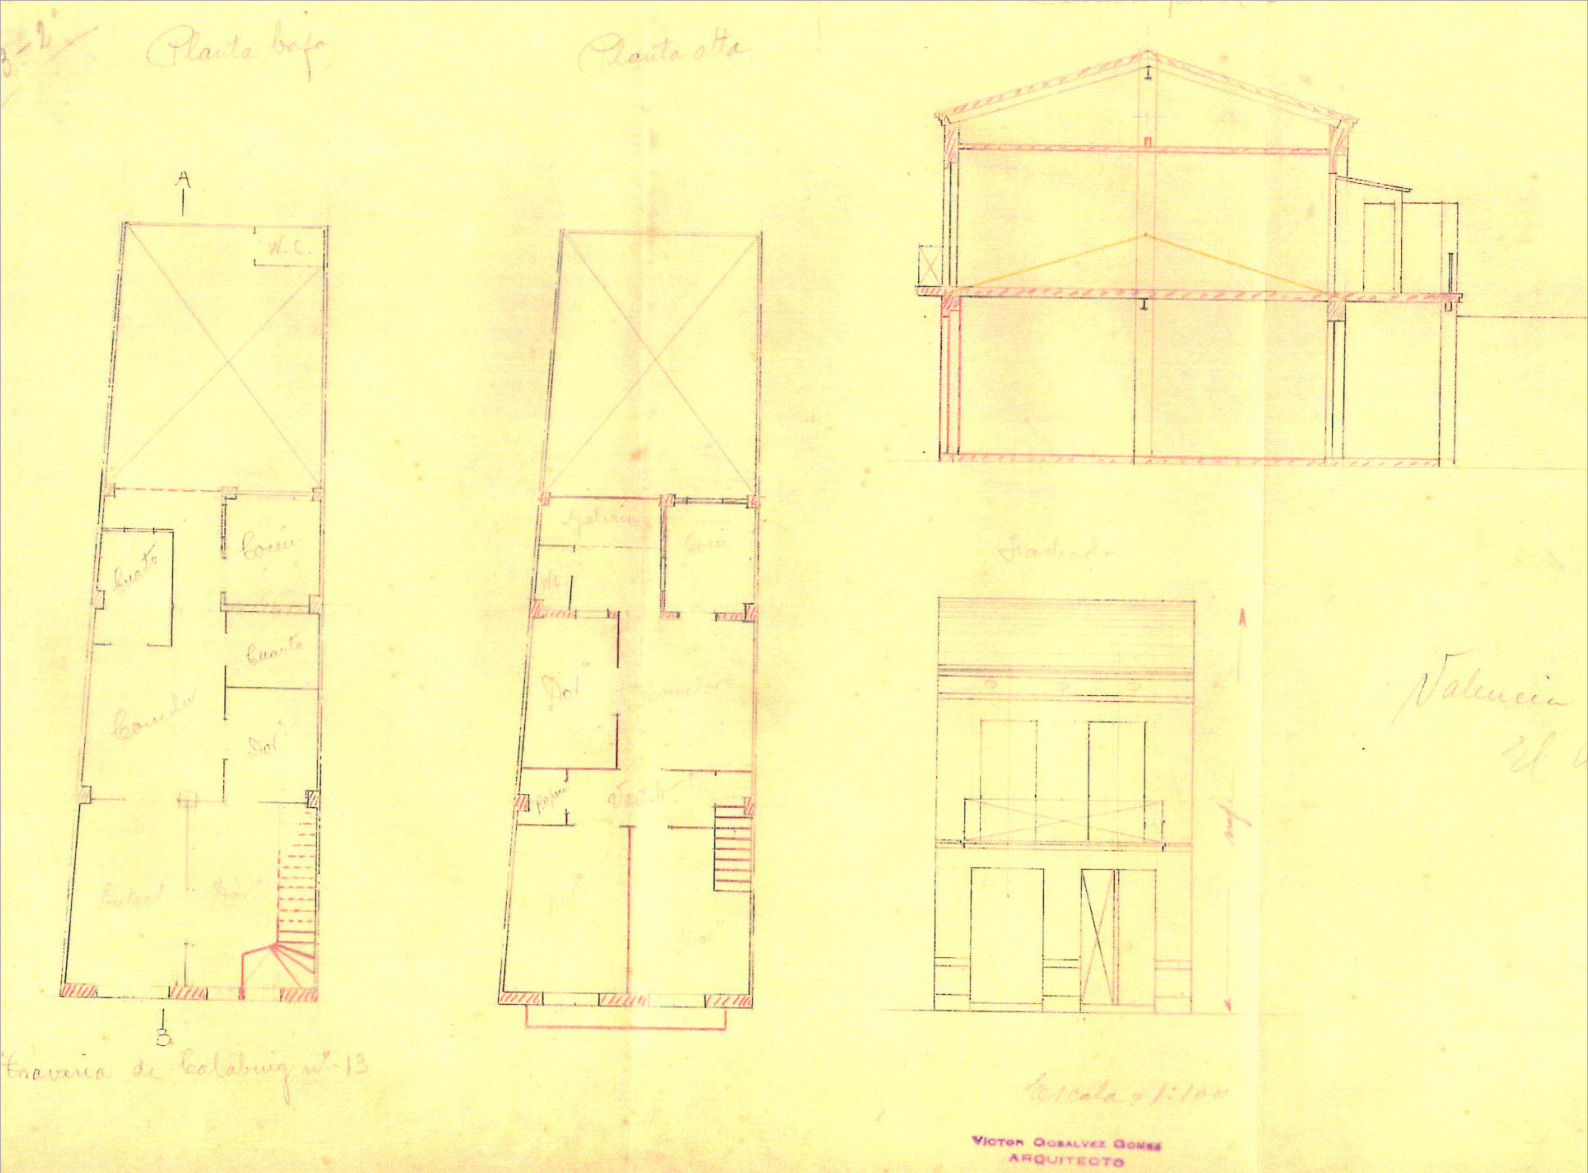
Proyecto de elevación de piso y reconstrucción de fachada en Travesía de Calabuig (1936). (Fondo Sandro Pons Romani)
